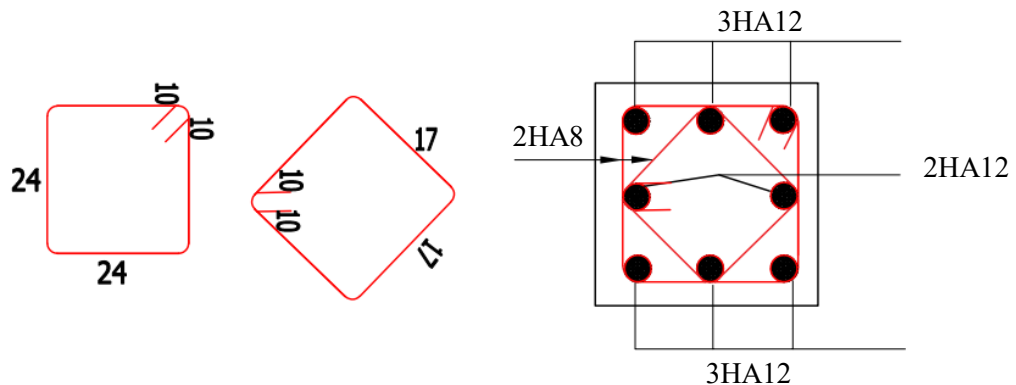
Schéma ferrailage Poteaux (30 x 30)
